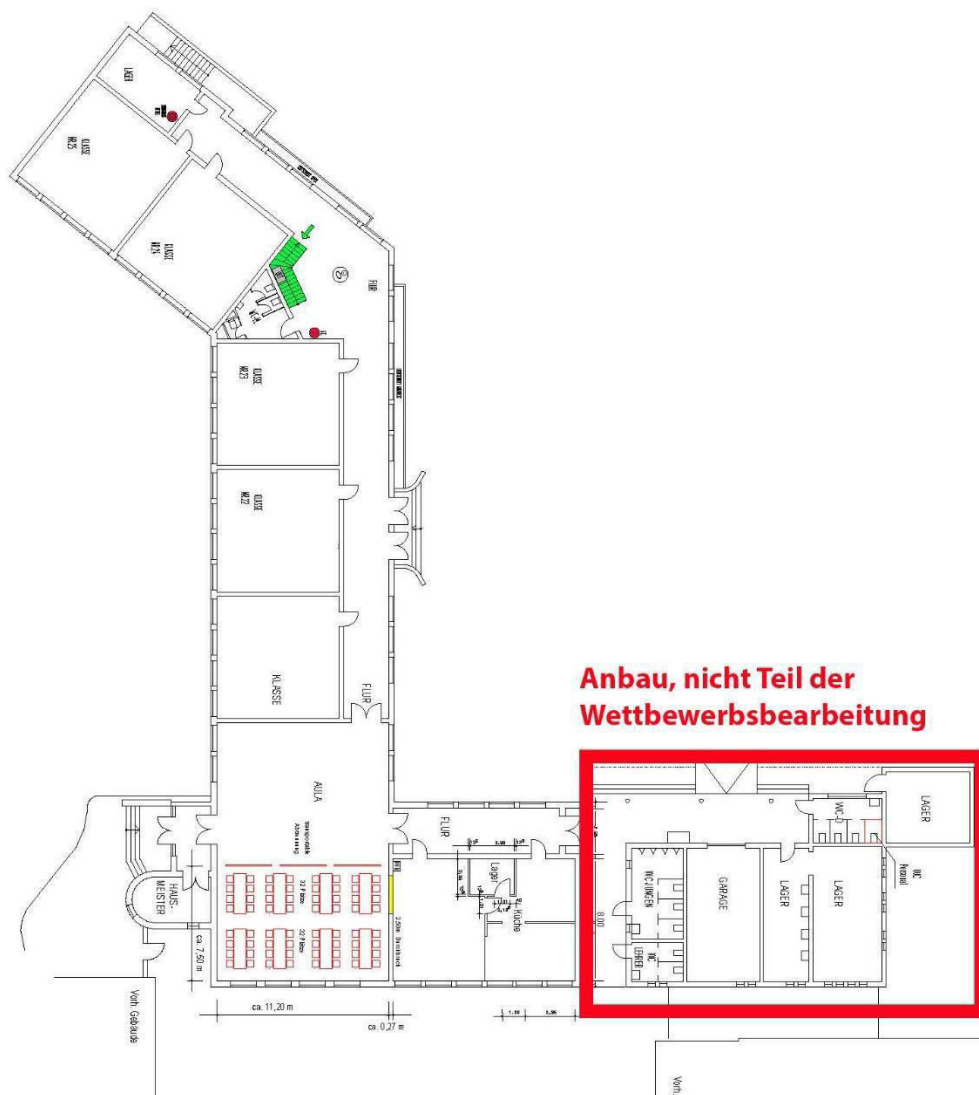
Grundriss EG „Holländertrakt“ (Quelle: Stadt Zeven)
